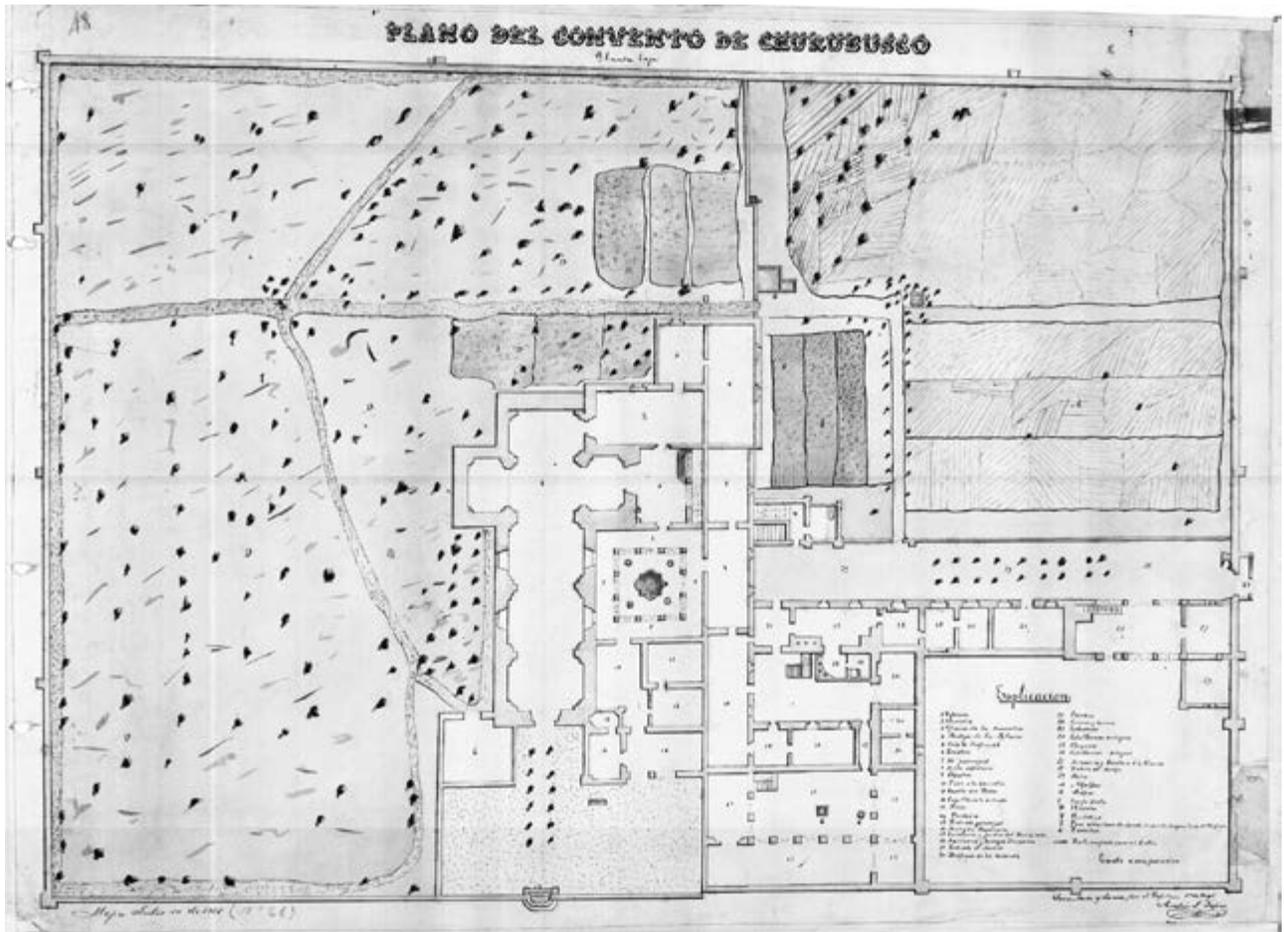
Planta baja del ex convento de Churubusco, "Levantado y lavado por el Capitán de 1º de Rango Andrés S. Tapia; 1866", Mapoteca Manuel Orozco y Berra: PB-1460-25.
